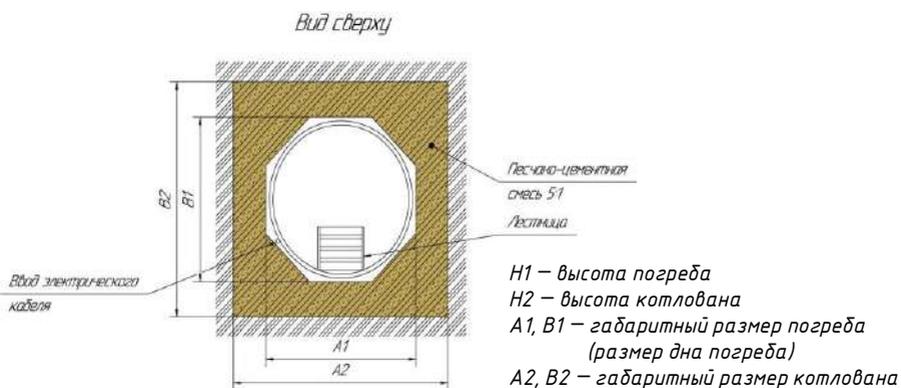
Обозначение габаритных размеров погребя в разрезе (вид сверху)
